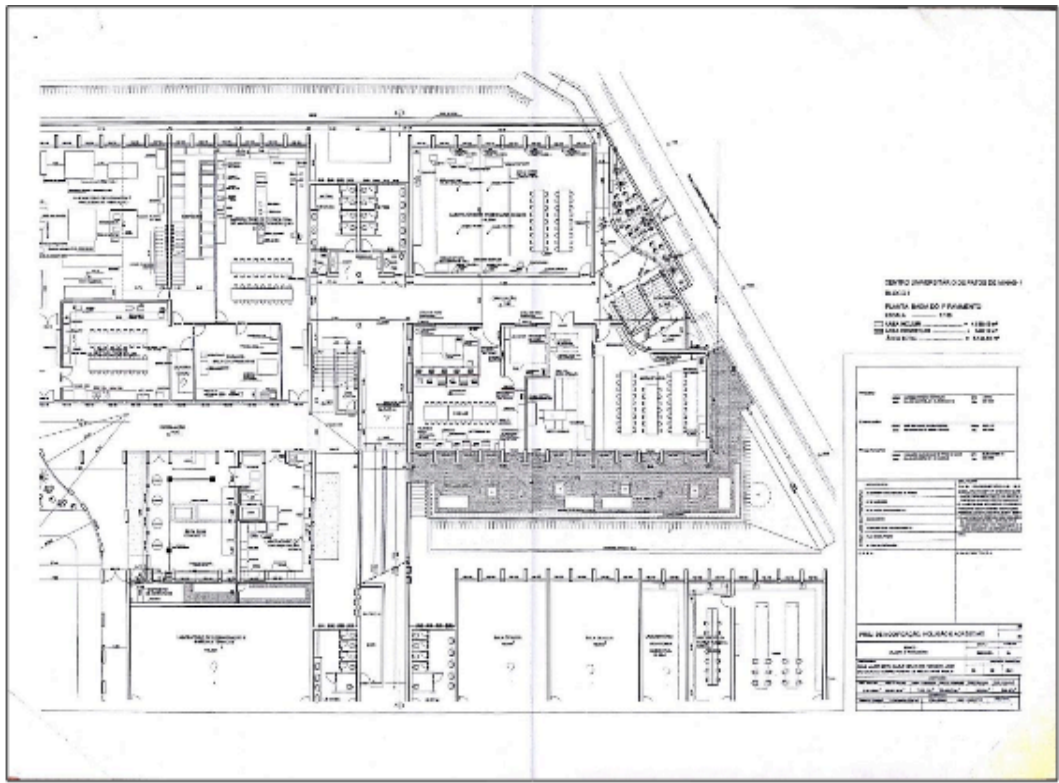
Planta baixa do 1º pavimento do bloco I do UNIPAM
